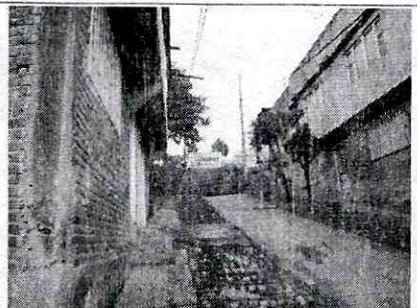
Vista actual del lote 8 donde se desarrollara el proyecto localizado en la Calle 37B Sur No 1 - 11 Manzana Catastral 37.
